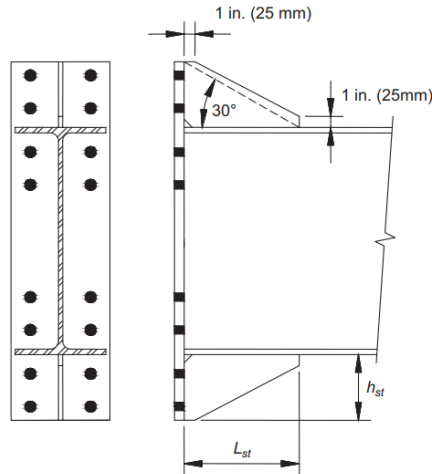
Disposición del atiesador en una conexión de plancha extrema 8ES. Fuente: ANSI/AISC 358-22.
